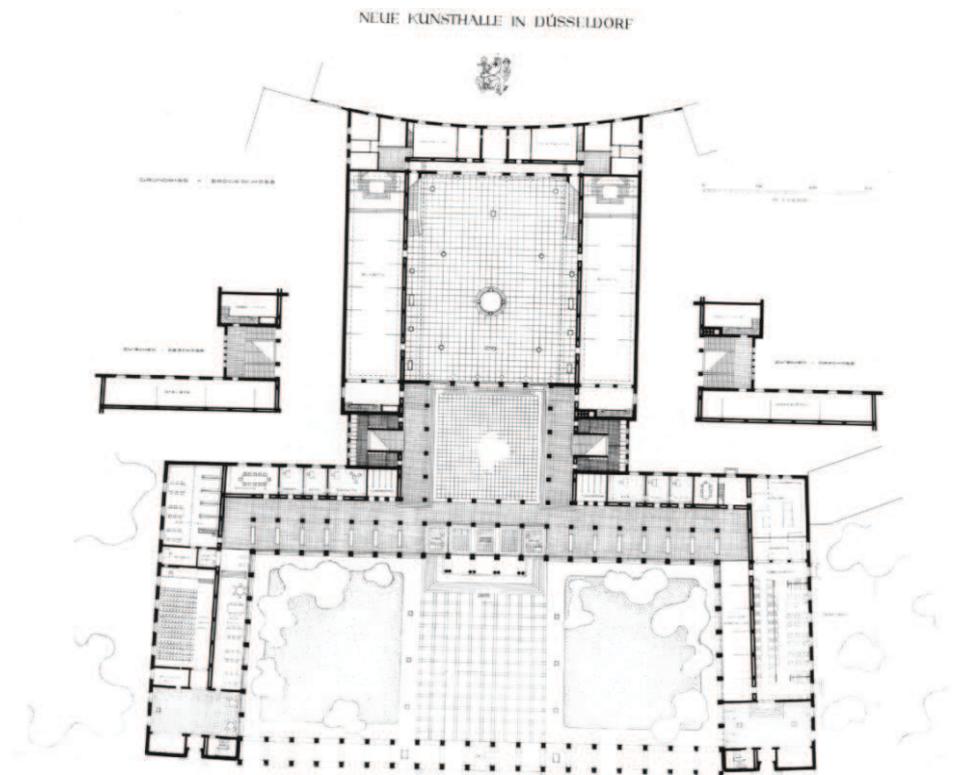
Gerhard Graubner, Projekt Kunsthalle Düsseldorf, Grundriss Erdgeschoss (Archiv Rotermund-Lehmbruck Karlsruhe)
